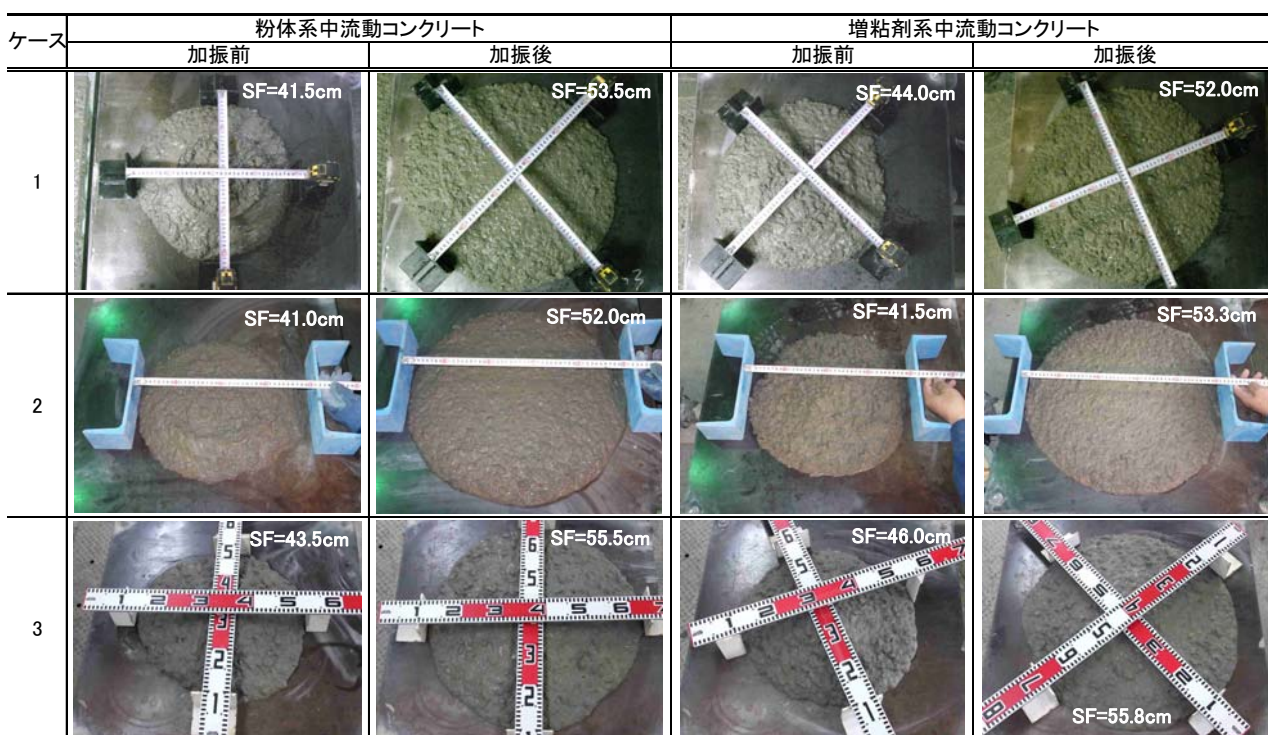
加振変形試験前後の各種中流動コンクリートの状況
